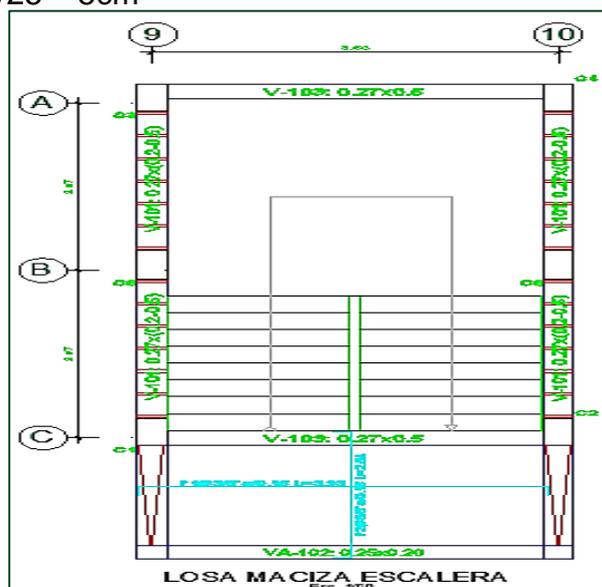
MODELO DE LOSA MACIZA ESCALERA
